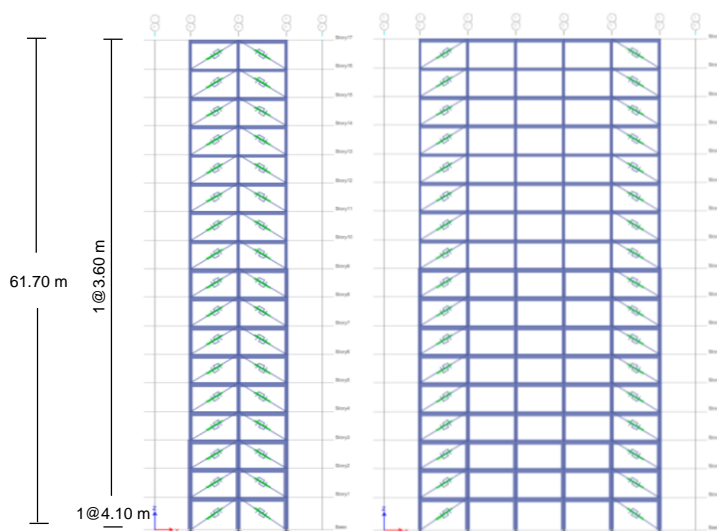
Disposición de BPR en altura, se tiene en la dirección transversal los planos A y H, en la dirección longitudinal los planos 1 y 5.
